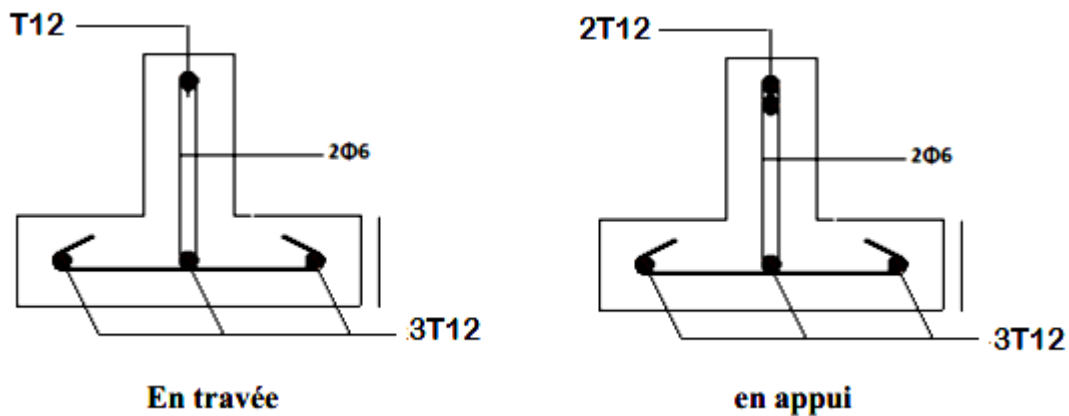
Schéma de ferrailage des poutrelles pour les deux blocs.
